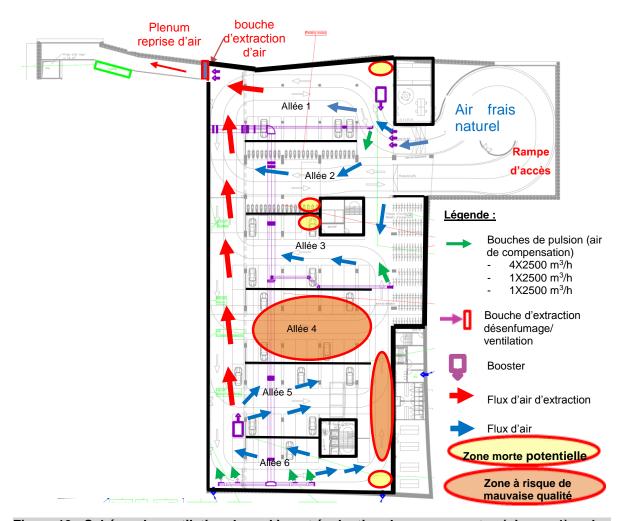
Schéma de ventilation du parking et évaluation des zones mortes (niveau -1) – plan de la demande de permis
